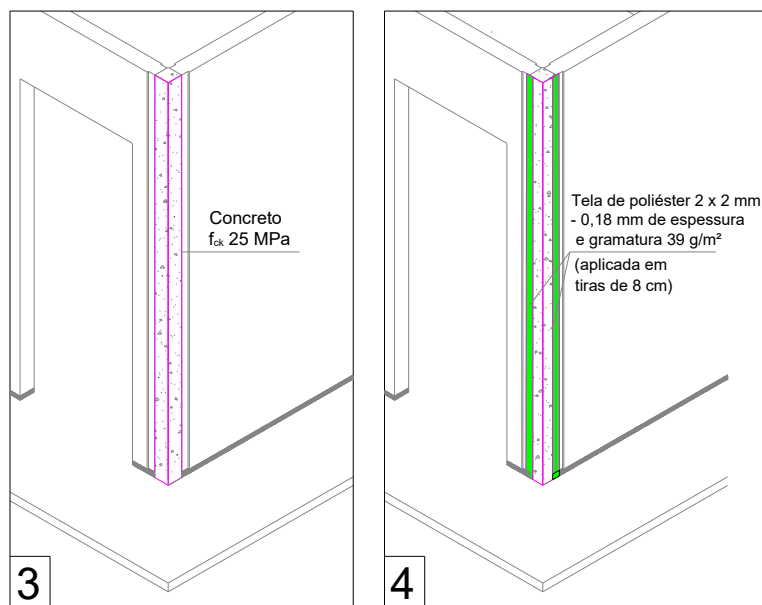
Sequência final da junção entre painéis de mesma espessura: (3) concretagem; (4) aplicação de tela de reforço.
